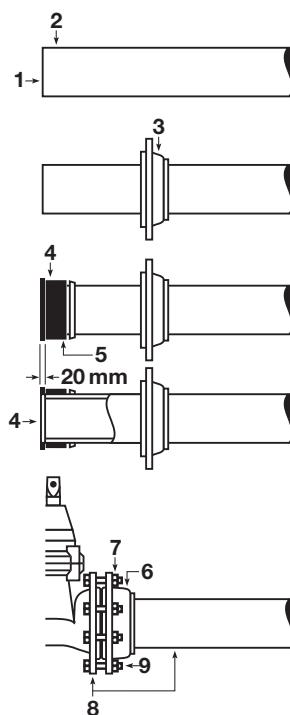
Схема присоединения устойчивого к растягивающим нагрузкам свободного фланца для ПВХ труб.
